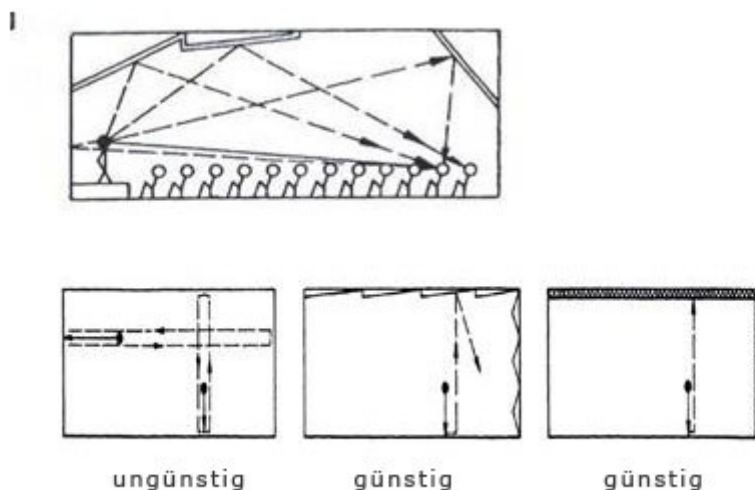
Akustisch ungünstige und günstige Raumgestaltung (oben Aufriss einer günstigen Anordnung, unten Grundrisse)
